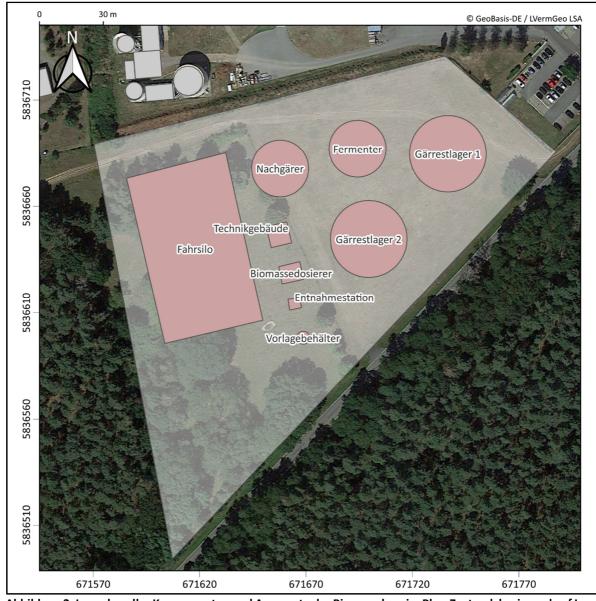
Lageplan aller Komponenten und Aggregate der Biogasanlage im Plan-Zustand, basierend auf Lageplan der ATP architekten ingenieure vom 15.05.2023
